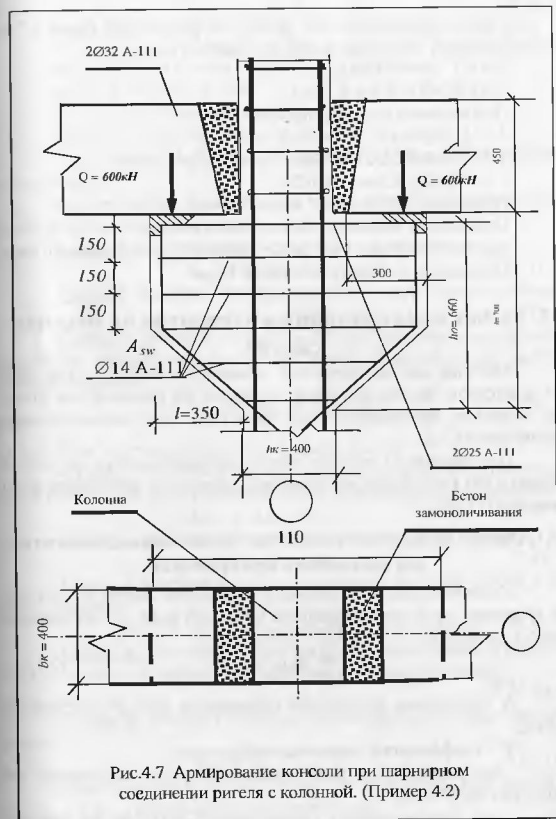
Армирование консоли при шарнирном соединении ригеля с колонной. (Пример 4.2)
